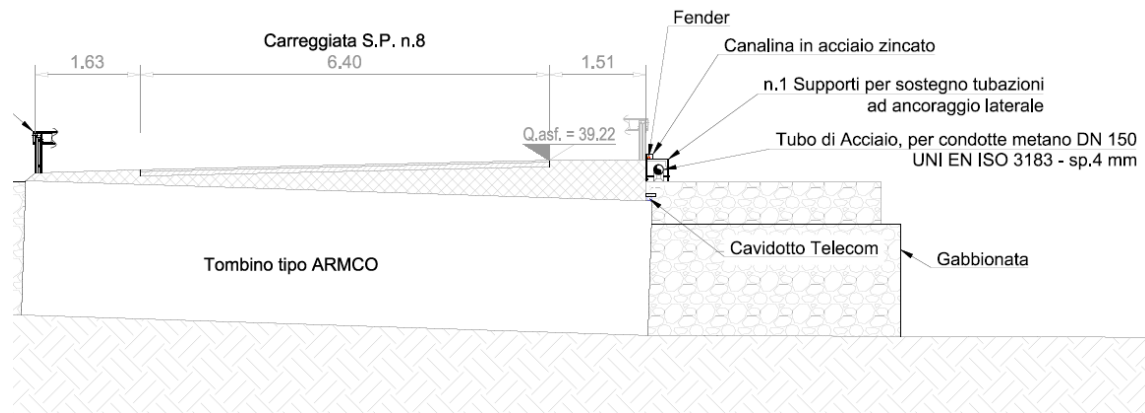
Sezione di progetto 2 – Attraversamento Rio Cintroxu
